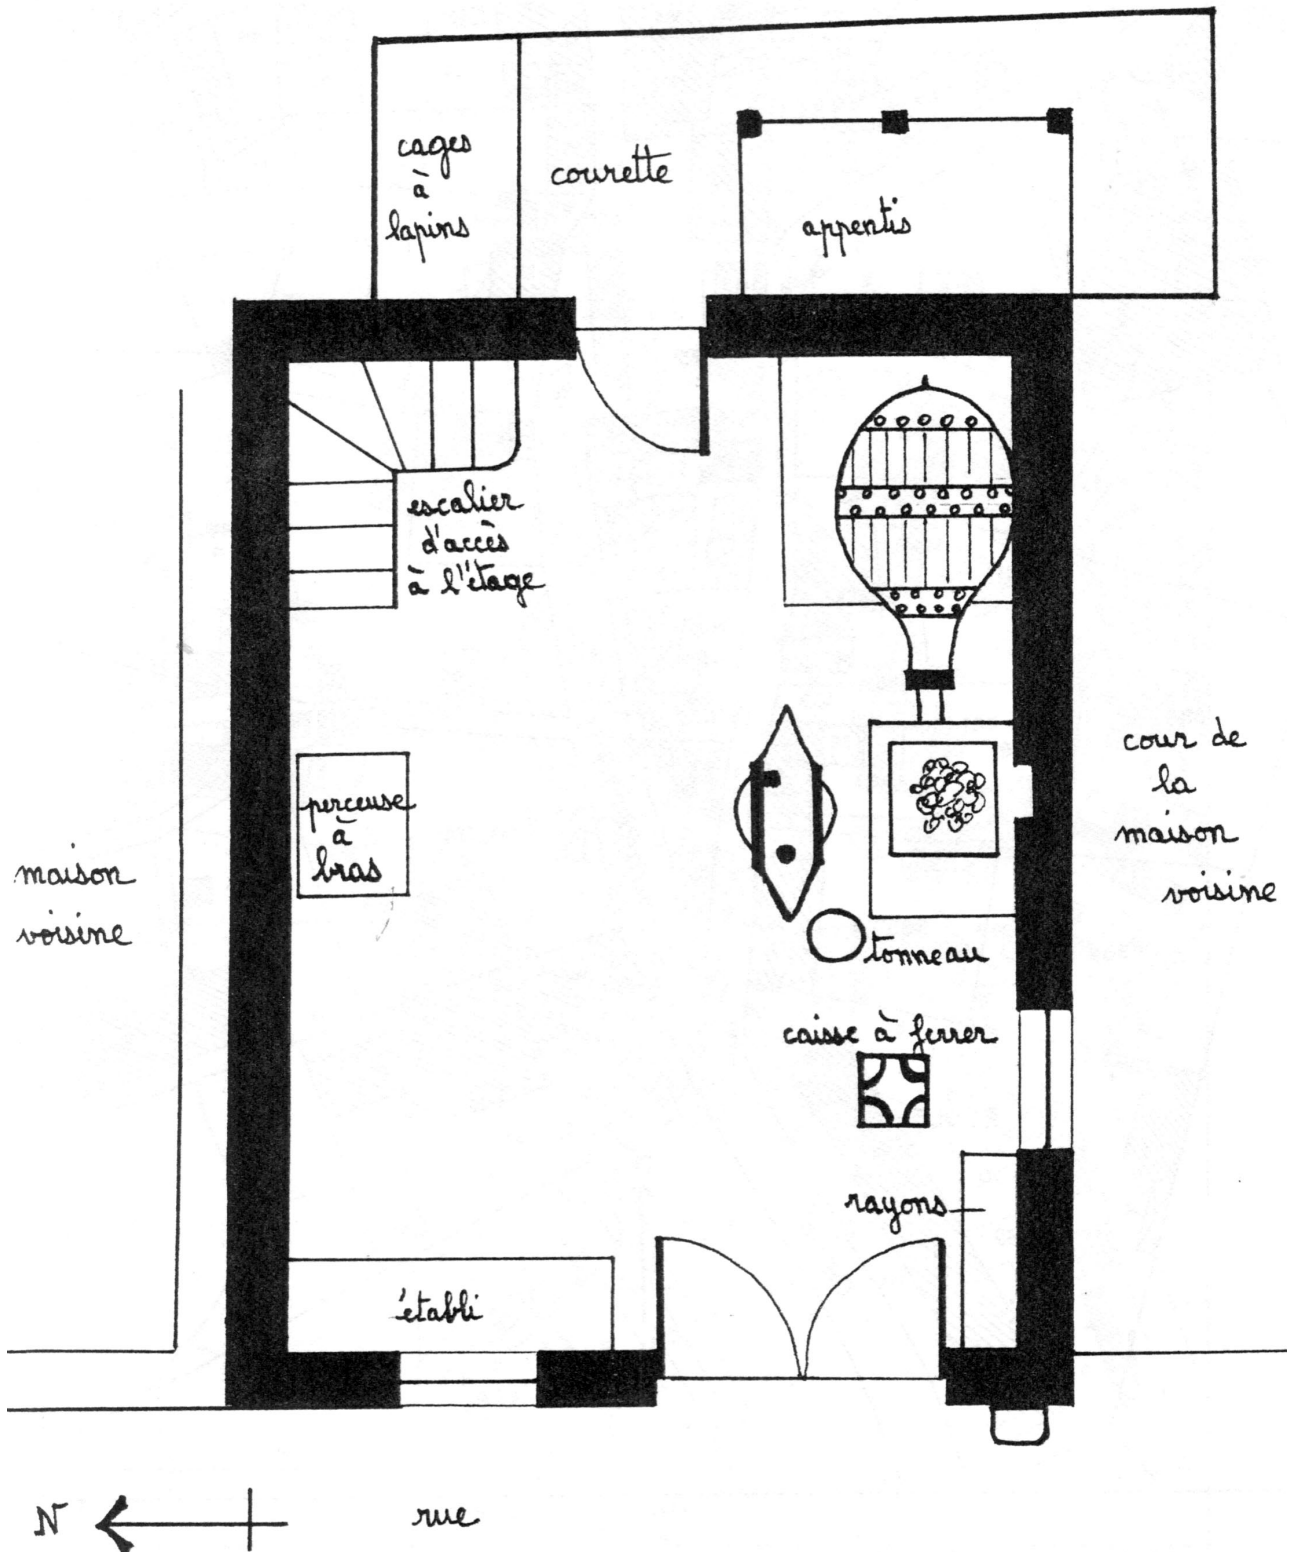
Plan de l'atelier de François Forrêt (échelle 1/50)
